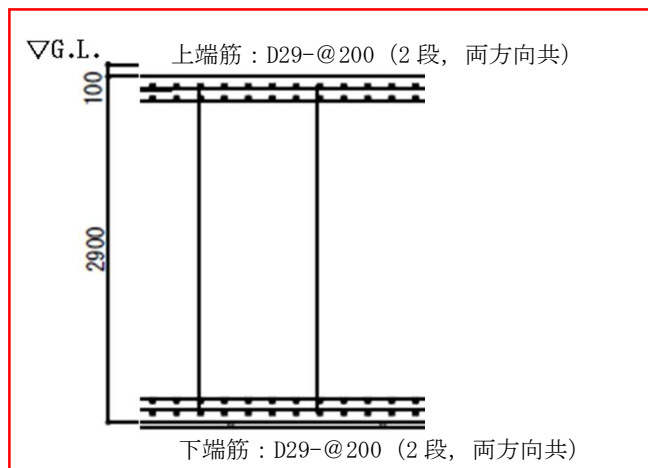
(7) 基礎配筋图 (一般部) (单位：mm)
